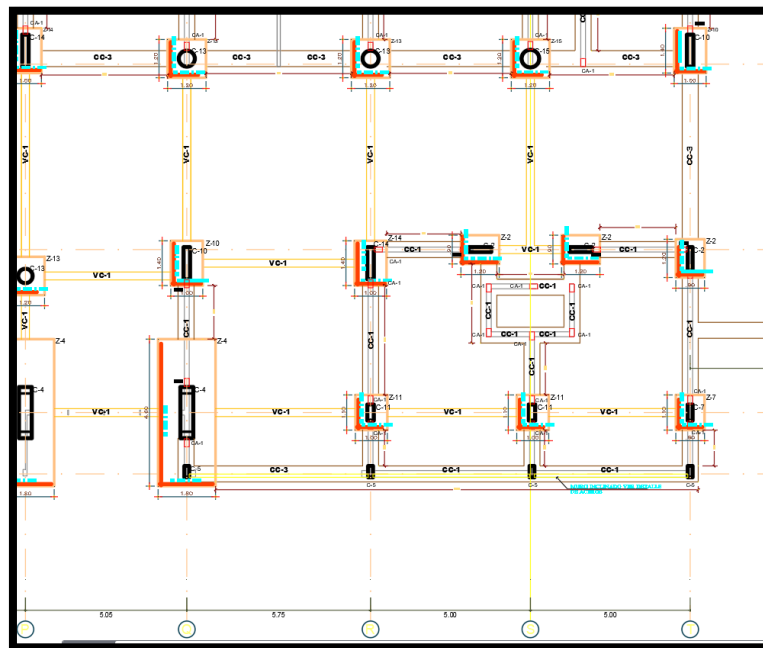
Se aprecia planta de ingreso de la edificación entre los ejes 4-8 y Q-T
